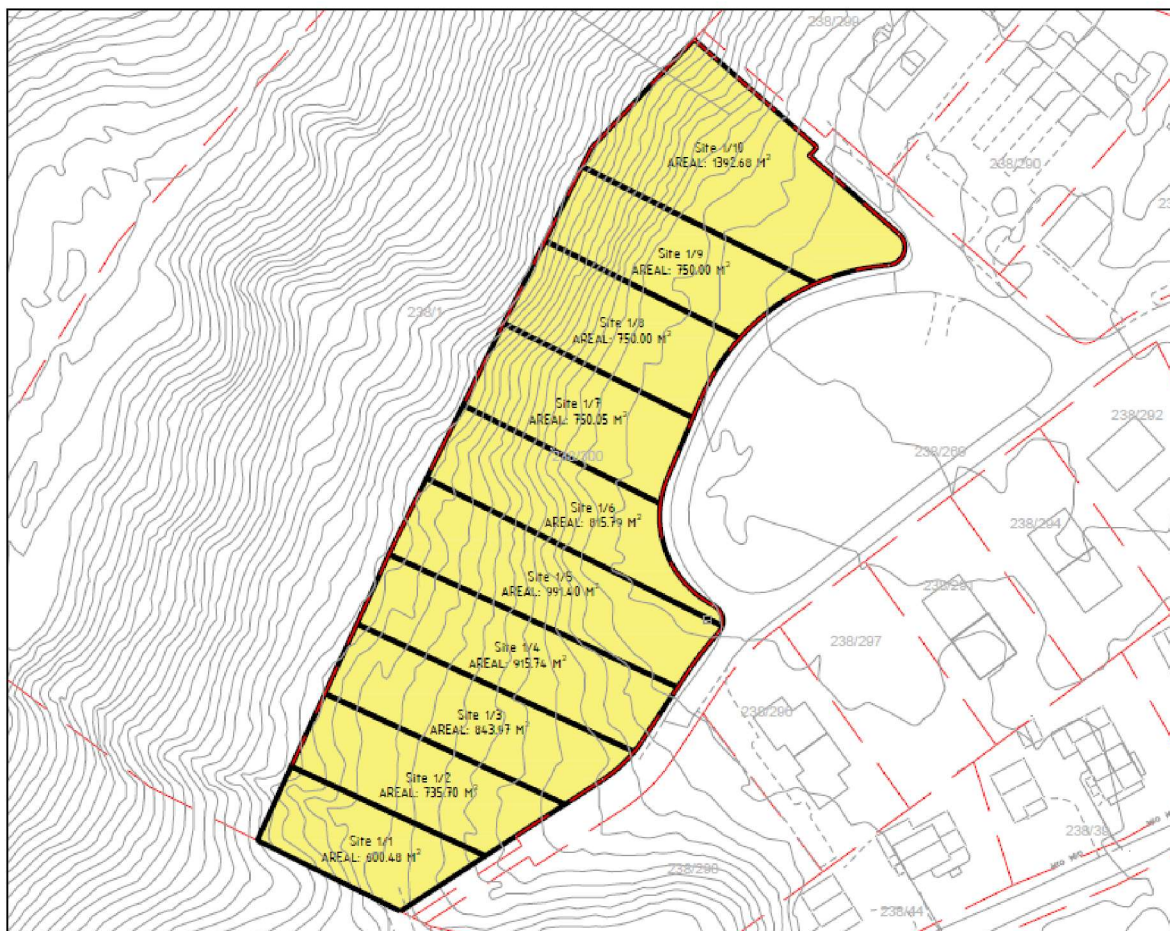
I gjeldende plan er tomte avsatt til frittliggende bebyggelse.
